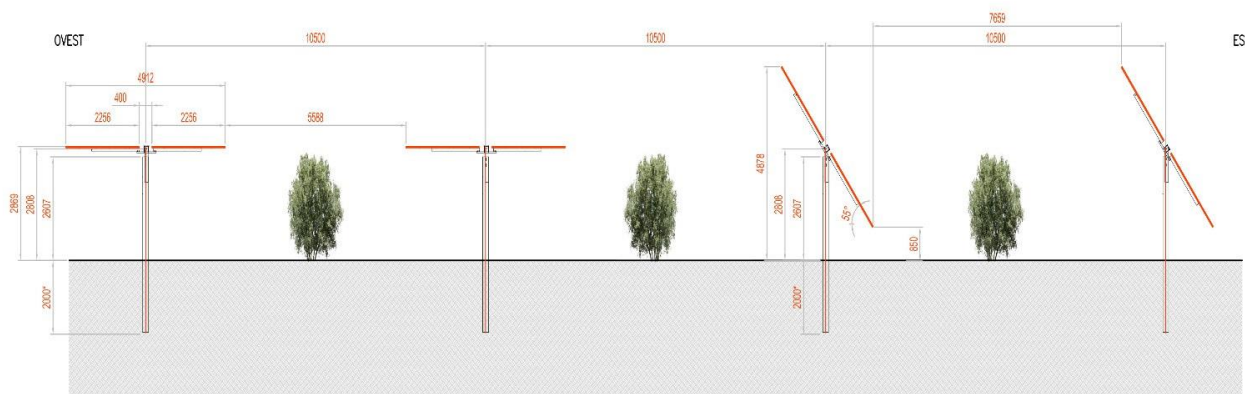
Tipologico – Vista Planimetrica dell'impianto Olivicolo
